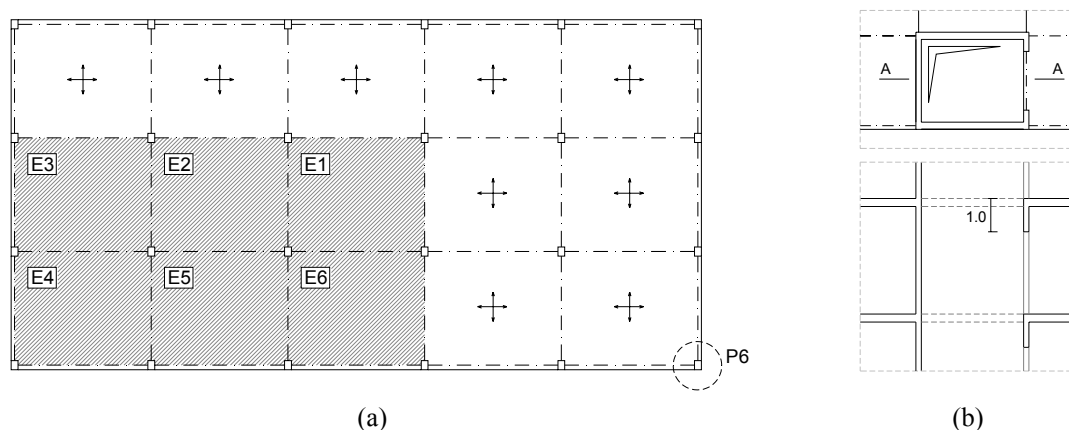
Núcleo resistente: (a) Planta esquemática das seis localizações estudadas; (b) Planta e alçado.
